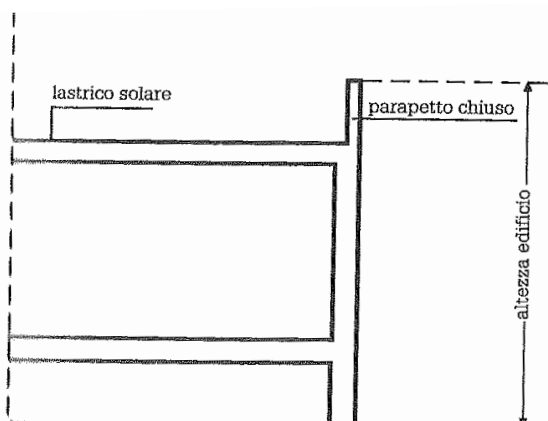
Edificio con copertura piana, parapetto chiuso e lastrico solare
